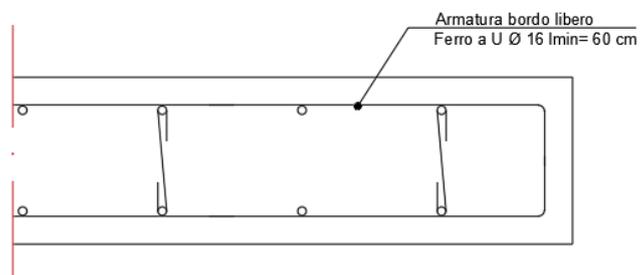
Dettaglio armatura bordo libero platea di fondazione
